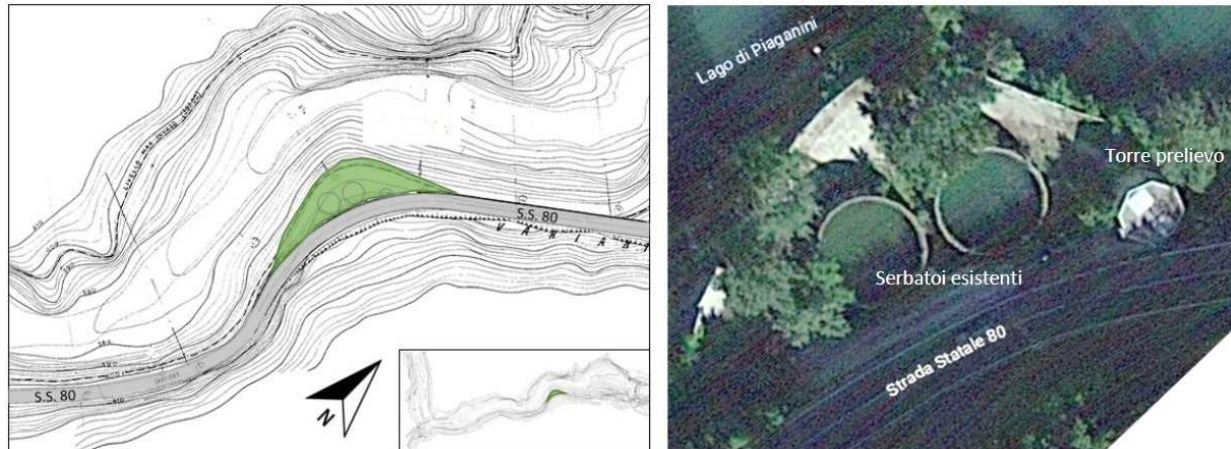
rappresentazione planimetrica dell'area in sponda destra ipotizzata per l'installazione a terra dell'impianto di trattamento
